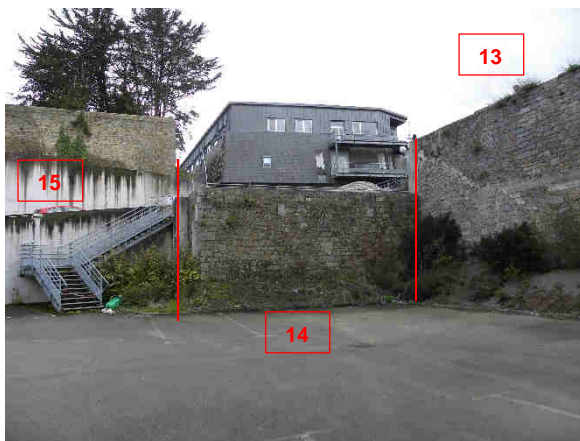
Mur N°14, Vue depuis la parcelle 546
